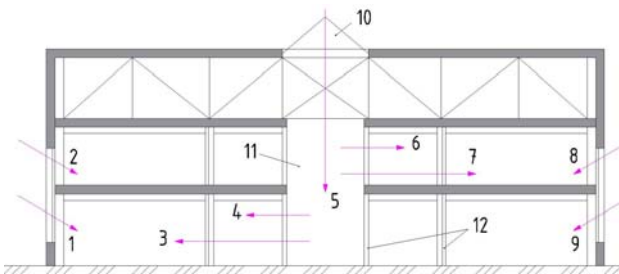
Рассматриваемое производственное здание после второго этапа перепрофилирования со световыми колодцами: 1-9 – прямые и вторичные световые потоки от окон и светового колодца; 10- зенитный фонарь; 11- световой колодец; 12- светопрозрачные перегородки.
